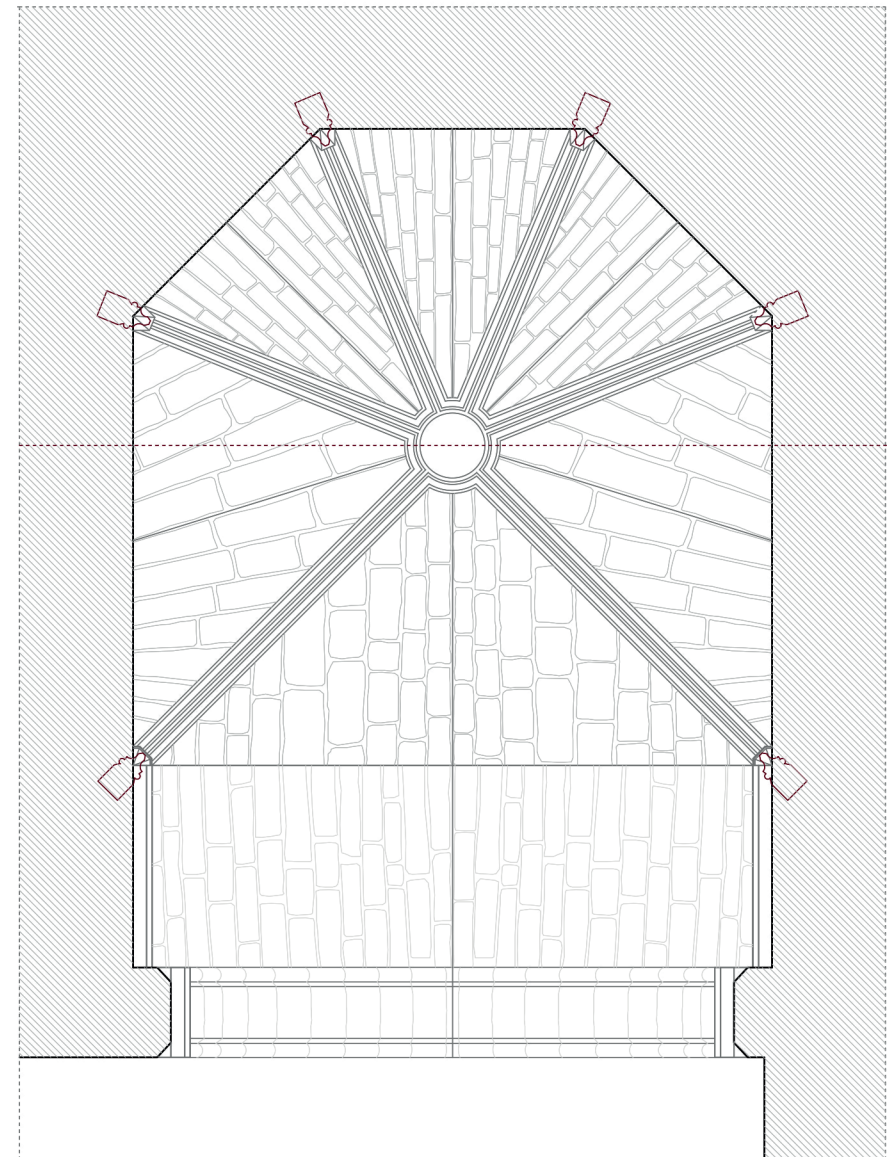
Planta cenital con despiece de plementería (Dibujo pro-
